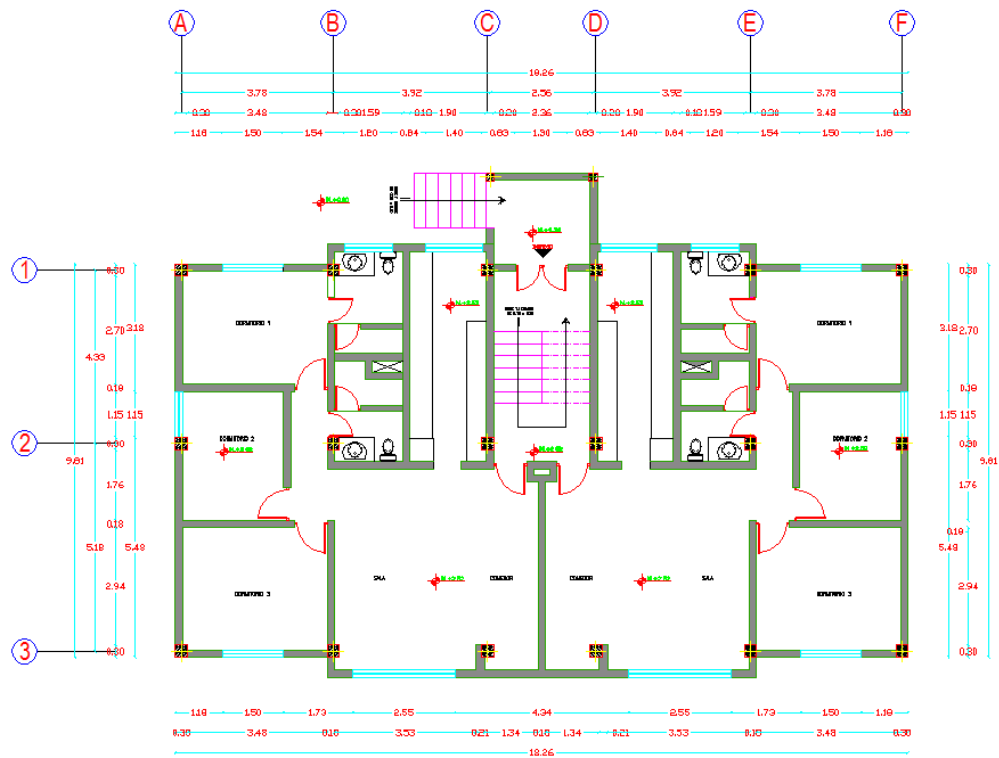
Levantamiento Arquitectónico Departamento Planta Alta
